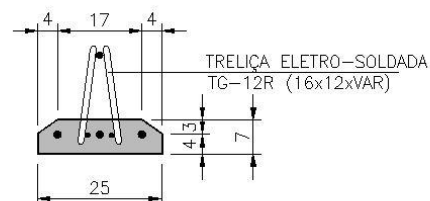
Dimensões das lajes pré-moldadas – Detalhes
